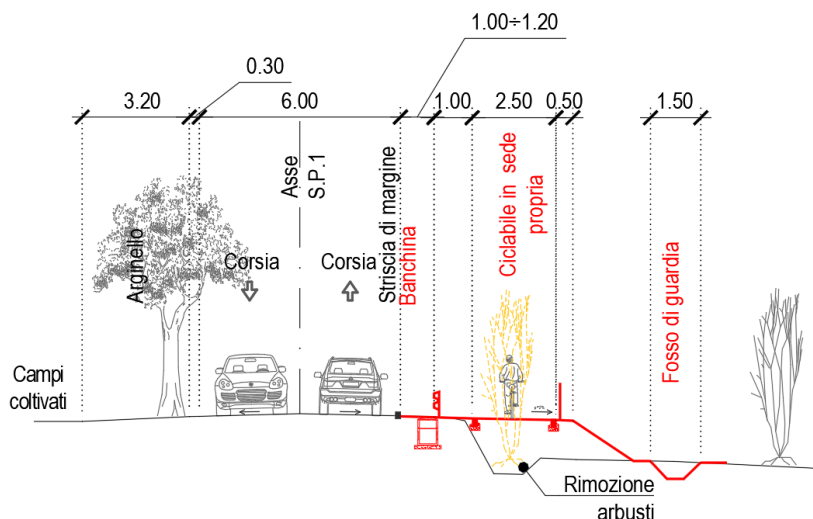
Soluzione di progetto tratto in appoggio al ponte sul Cavo Lama
